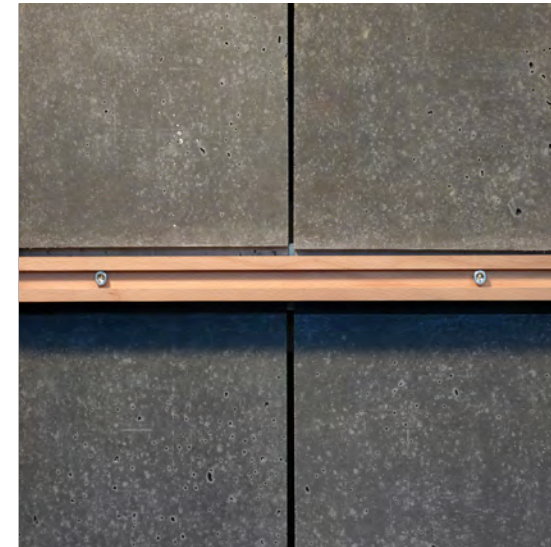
(links unten) Ansicht Musterkasten, Befestigungsvariante Typ C mit U-förmigen Deckprofil in Nut, die durch gefalzte Plattenkanten gebildet wird. Sichtbare Verschraubung mit Innensechskantschrauben
